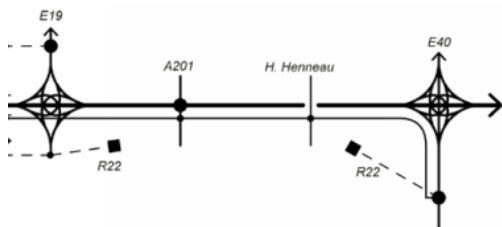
Alternative raisonnable distincte groupe 3 zone de Zaventem
